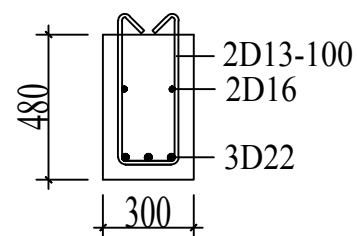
DETAIL BALOK INDUK TIPE B2A SETELAH KOMPOSIT
